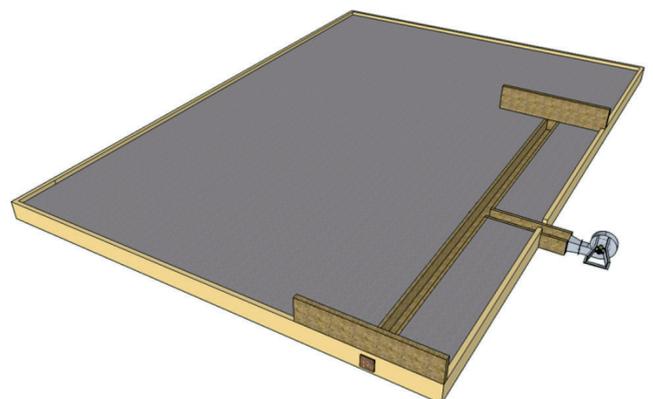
Construção dos canais (túneis) do terreiro híbrido abaixo do nível do terreiro convencional.
